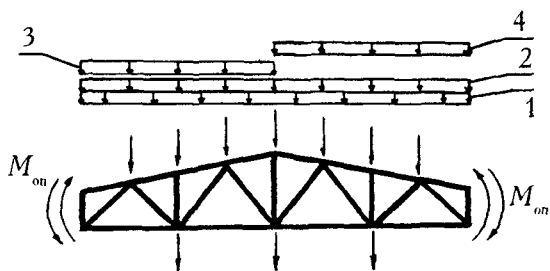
Нагрузки, действующие на ферму: 1 — нагрузка от собственного веса покрытия; 2 — снеговая по всему пролету; 3 — снеговая на левой половине фермы; 4 — то же на правой
